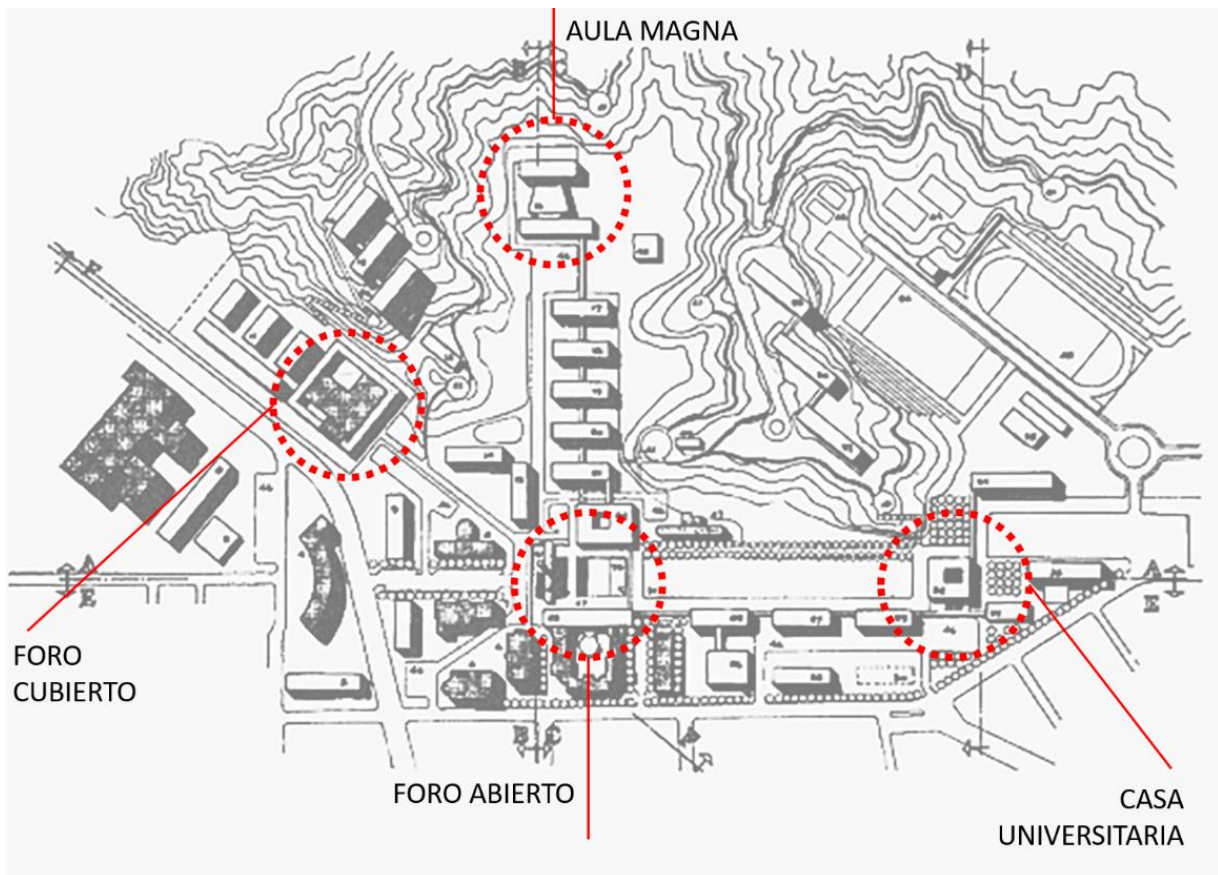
Planta del Plan Maestro para la Ciudad Universitaria de Concepción.⁵⁴
